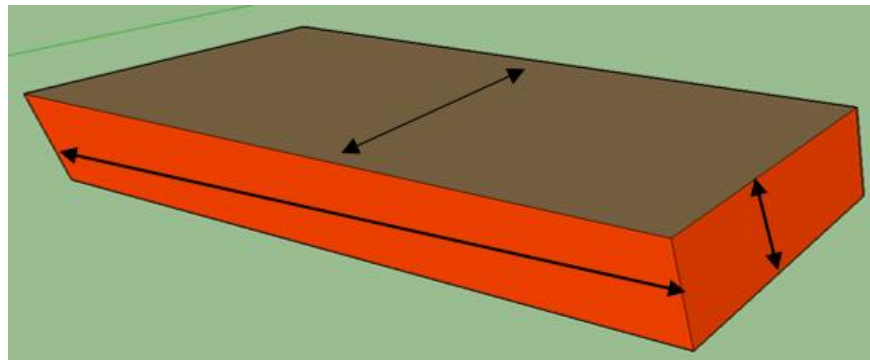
Dimensiones que se deben considerar en cada ecoladrillo.
